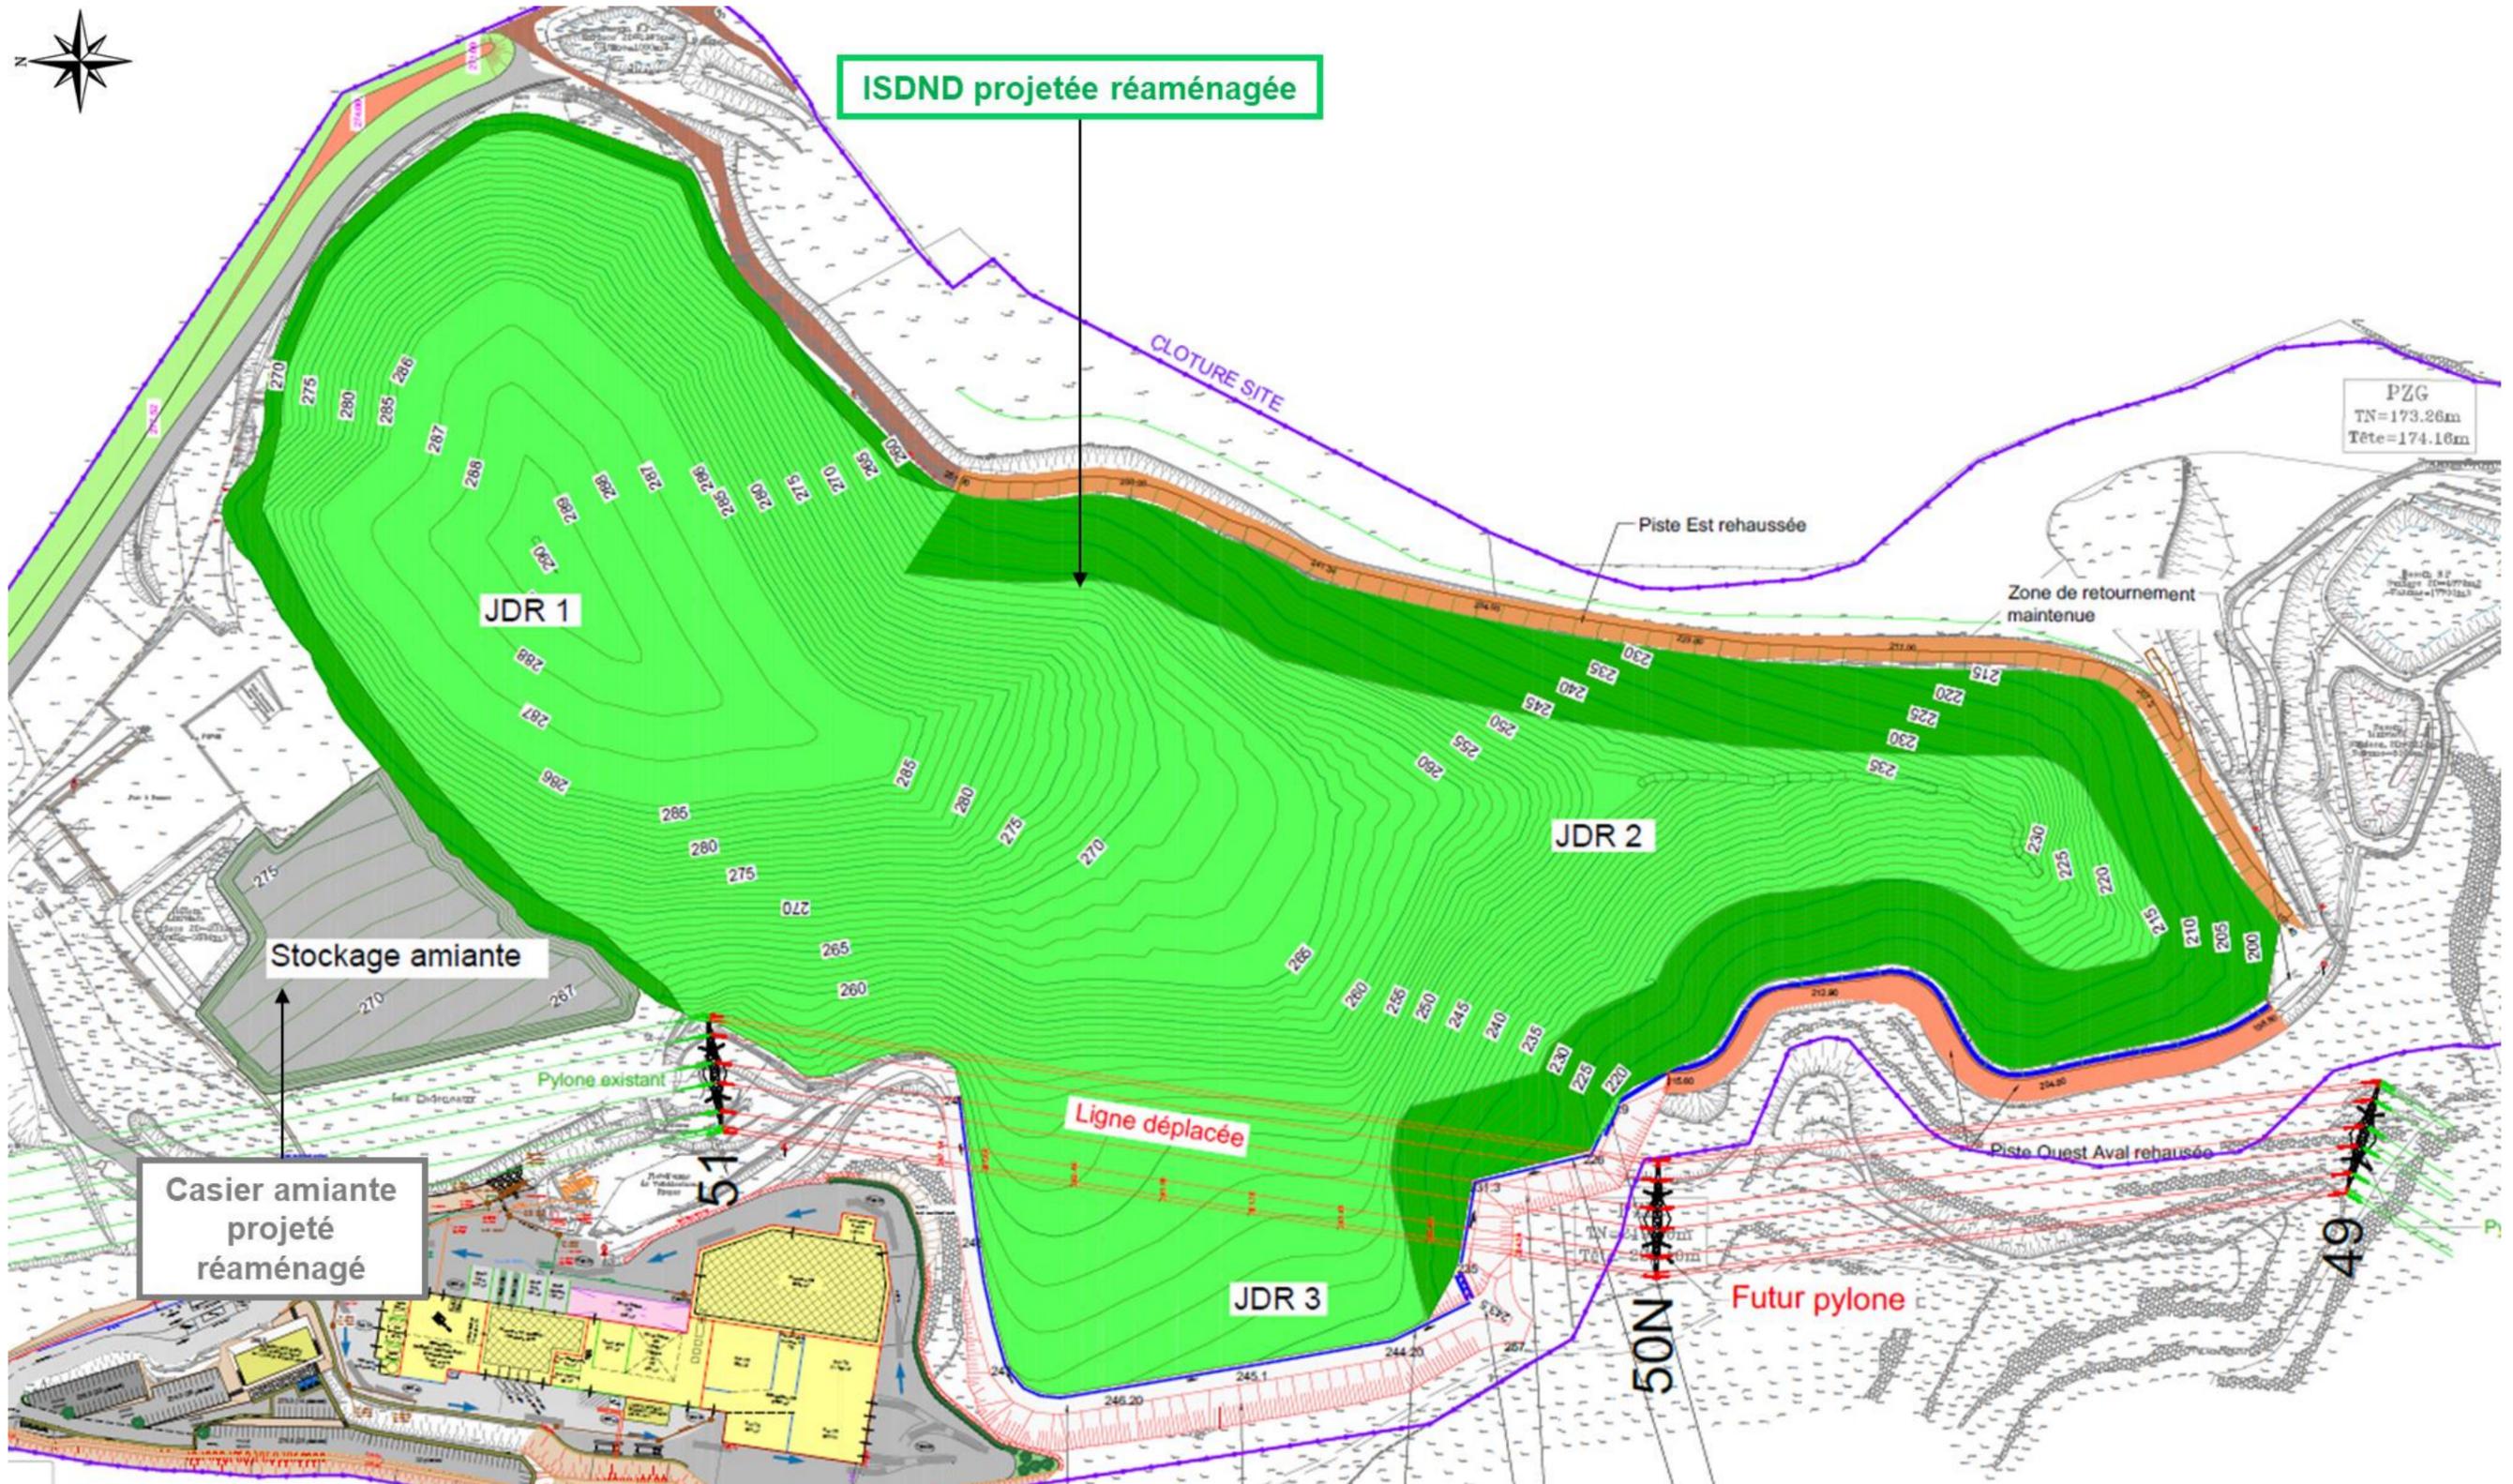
Plan de réaménagement final de l'ensemble du site (hors échelle)
